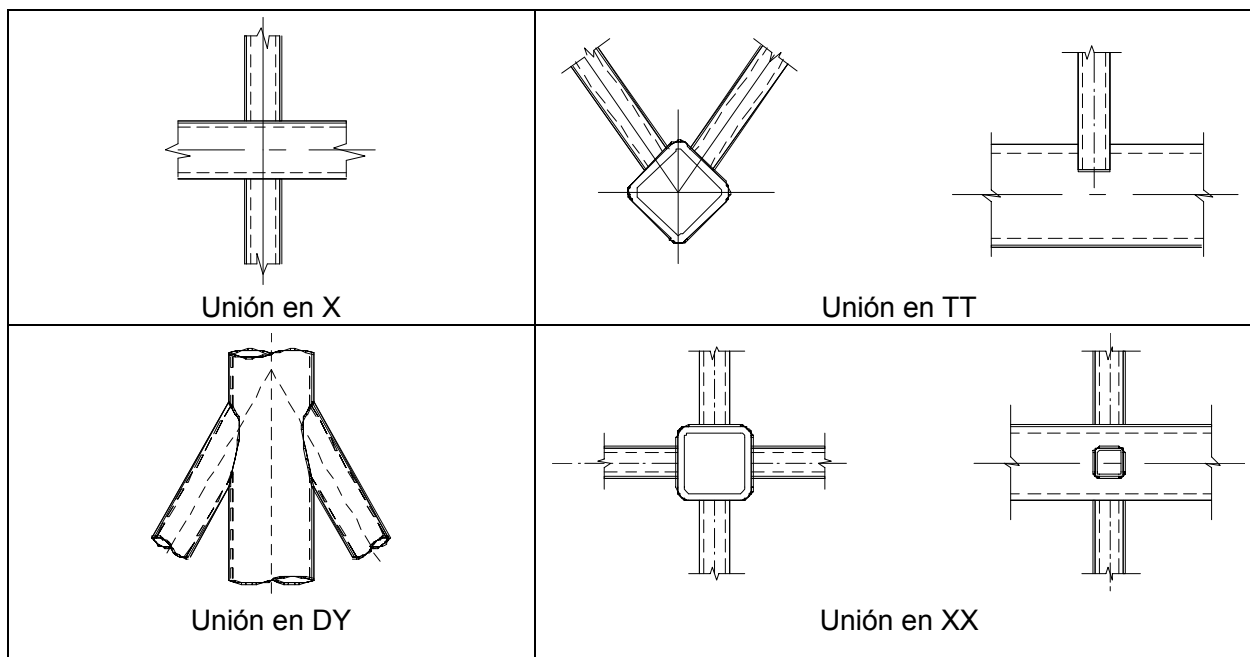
Tipos de uniones en vigas de celosía de perfiles tubulares
